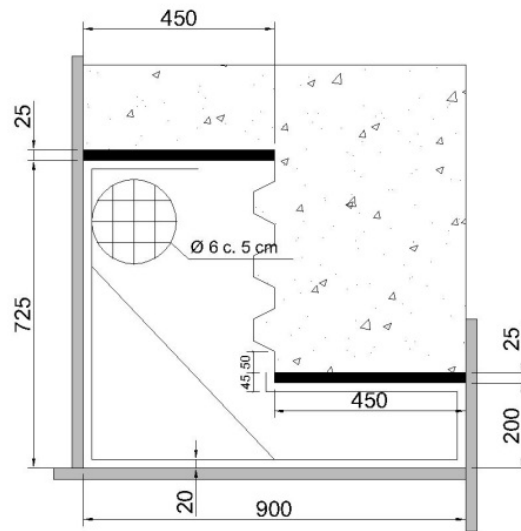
Encofrado y disposición de las barras y mallas electrosoldadas para la fabricación de la segunda pieza de hormigón para la junta de tres llaves (cotas en mm)
